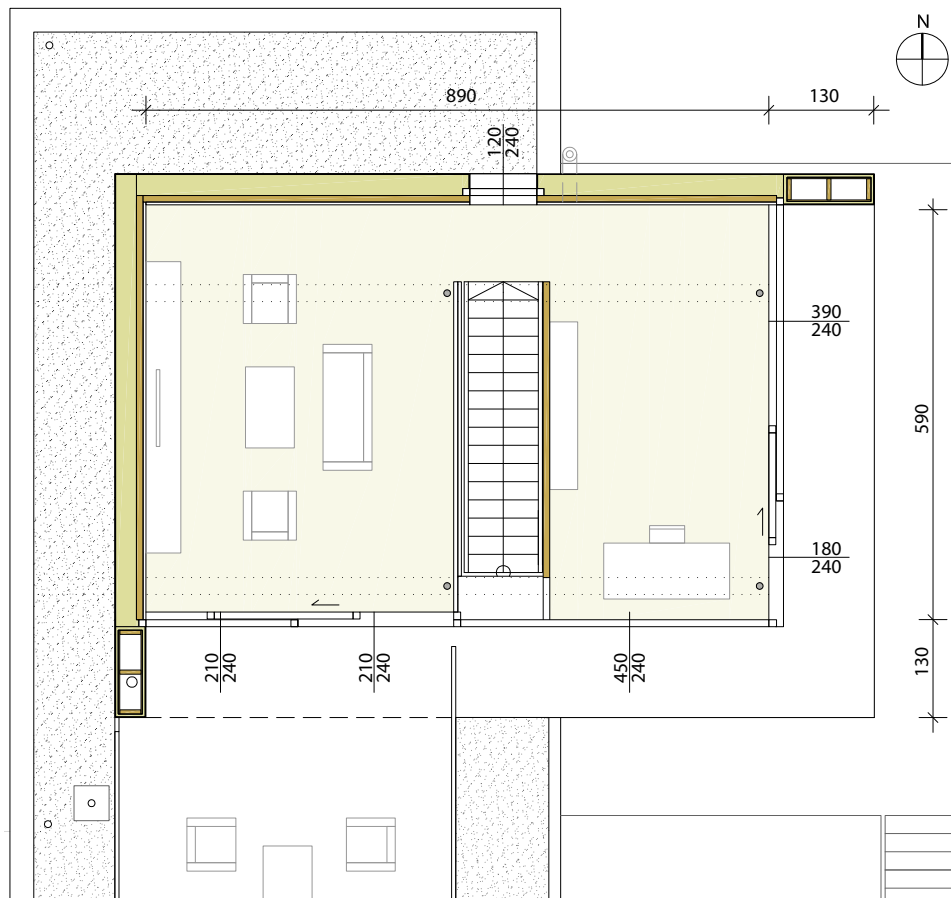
Grundriss Galeriegeschoss.
